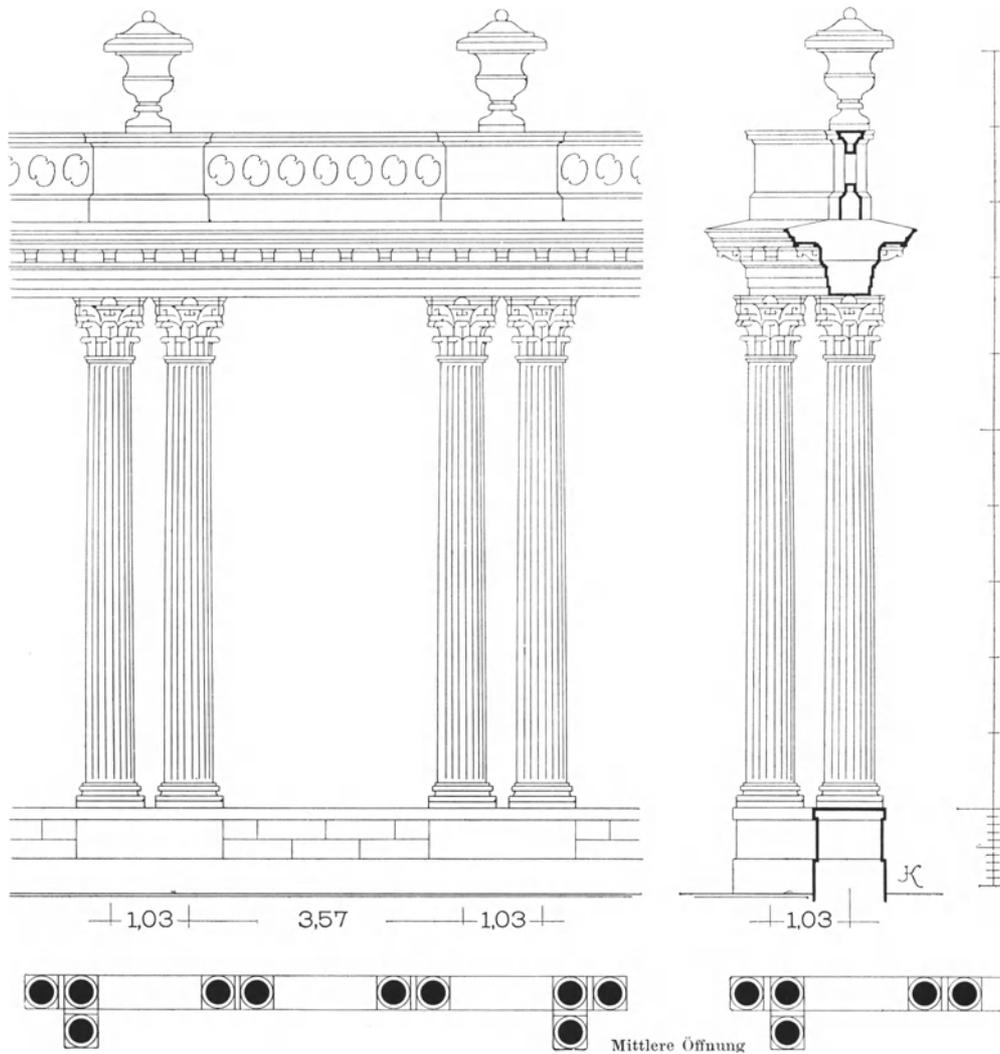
Umfriedung am Stadtschloß in Potsdam. Ansicht und Schnitt 1:100. Grundriß 1:200. Architekt v. Knobelsdorff.
